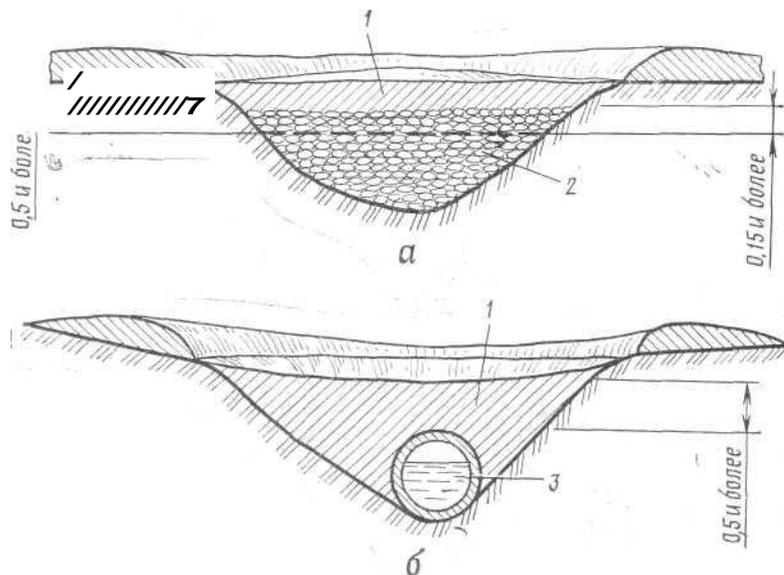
Схема перехода через воронку, заполненную водой на небольшую глубину (размеры в м): а — с устройством фильтрующей насыпи; б — с укладкой трубы; 1 — грунтовая отсыпка; 2 — камень, щебень, галька (бревна); 3 — труба
